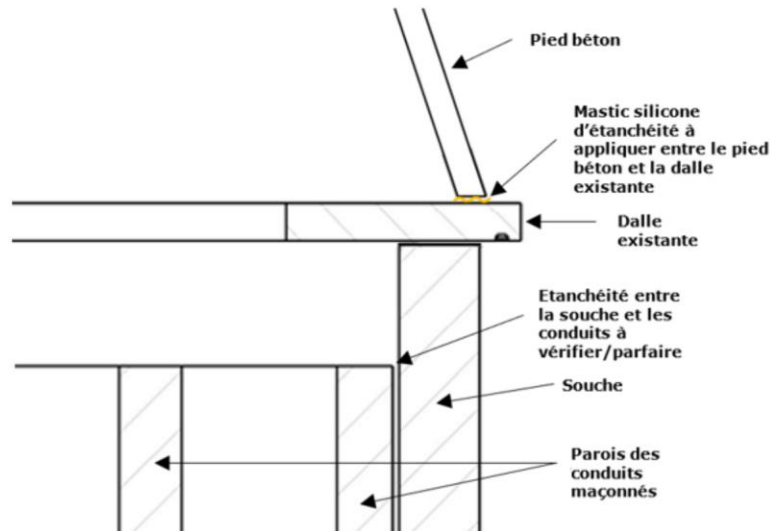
Coupe verticale d'un pied béton sur une dalle existante
